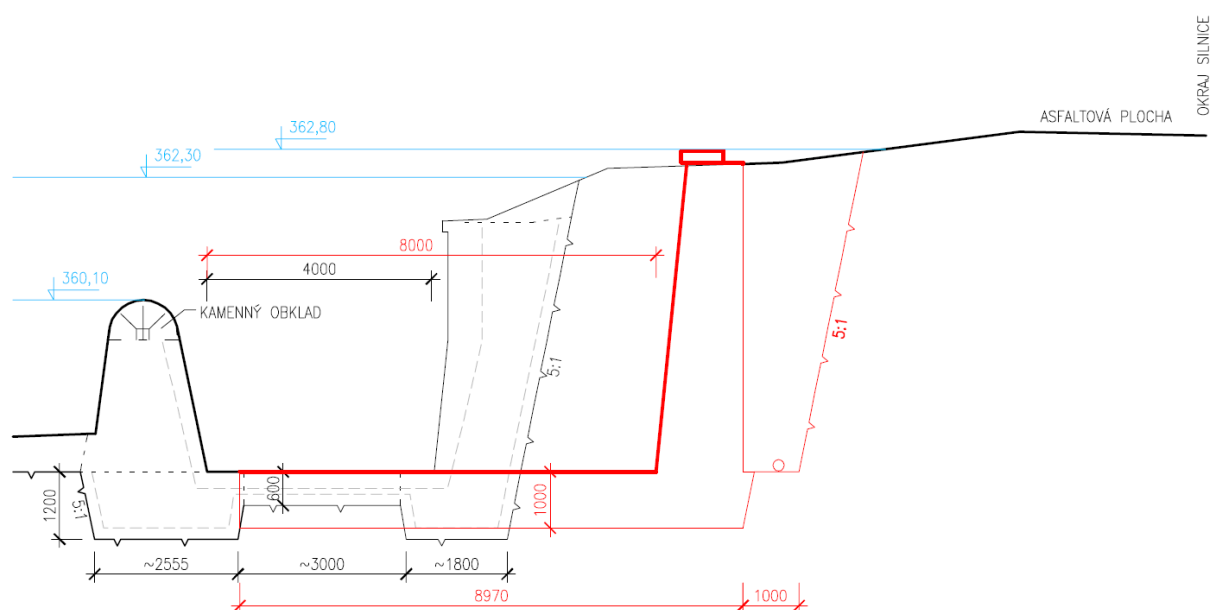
Přeliv a spadiště – půdorys úpravy šířky 8,0 m, variantní délky přelivu
